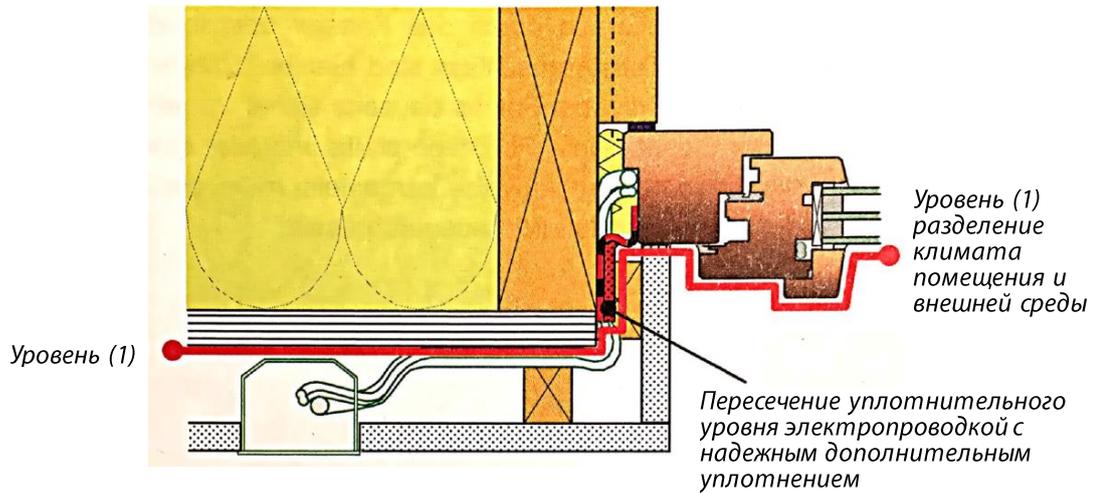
Особые мероприятия по уплотнению в месте пересечения электропроводкой уплотнительного уровня со стороны помещения в каркасной деревянной стене.
